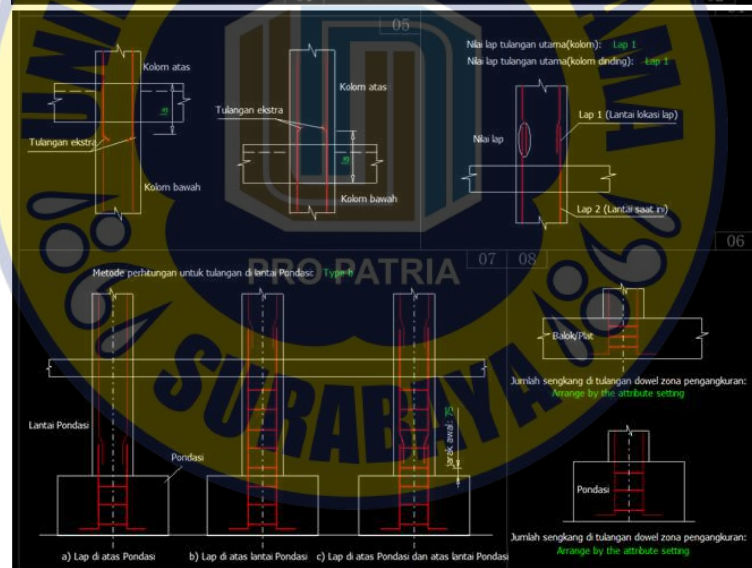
30 Penulangan Kolom Berdasarkan Detail Perencana. (a) Sambungan Lewatan Tulangan Kolom (b) Detail Penulangan Senggang pada Kolom
